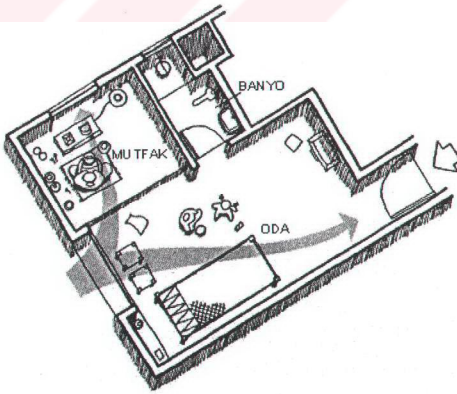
SEG Tower 11. kat planı, baumeister (1999)
